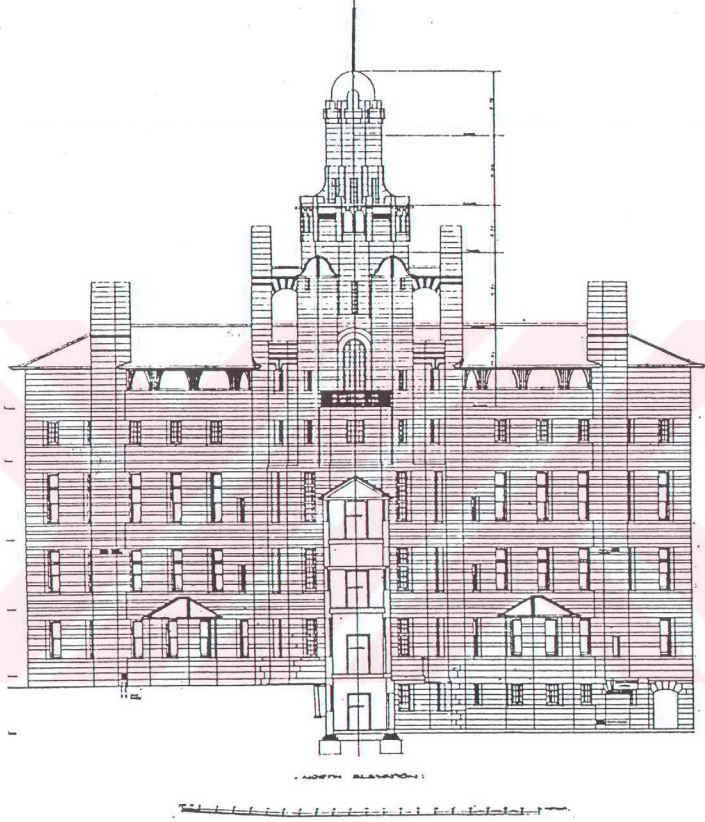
İngiliz Hastahanesi planları (Academy Architecture, 1902)
